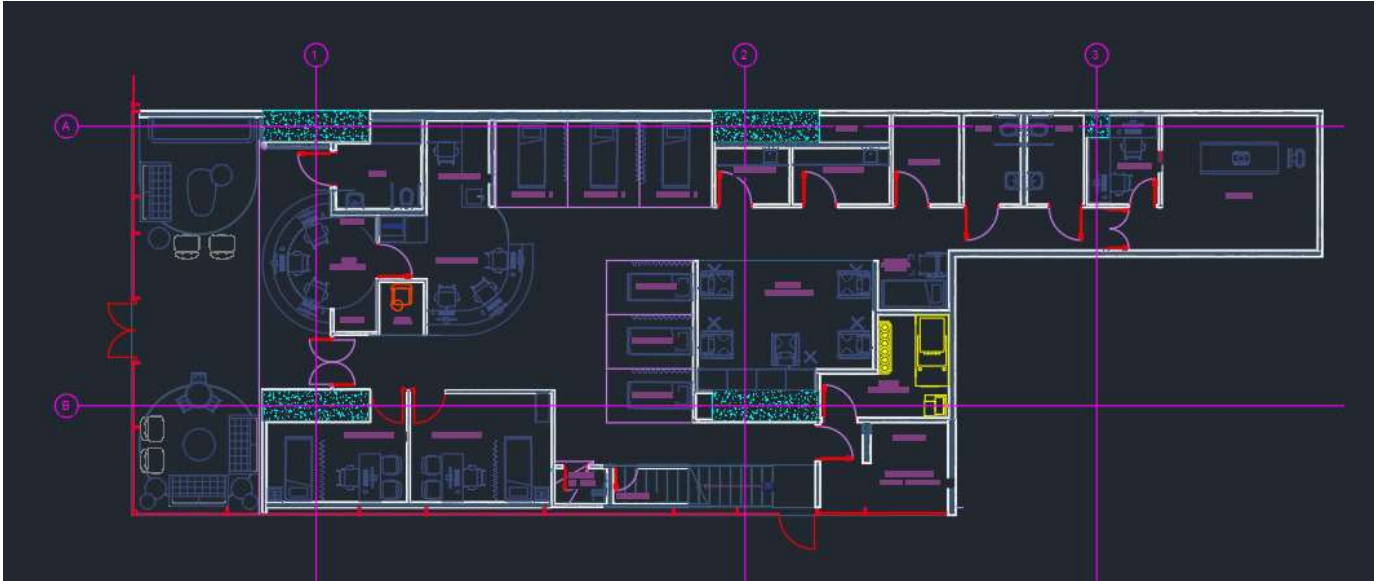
Vista de planta del programa AUTOCAD de la distribución de planta baja del Centro de Urgencias Grupo Nueve Once.
